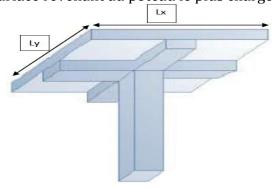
Dimensions du plancher revenant au poteau le plus sollicité.
